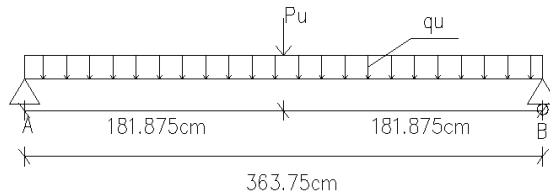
Balok Penggantung Lift yang Direncanakan
